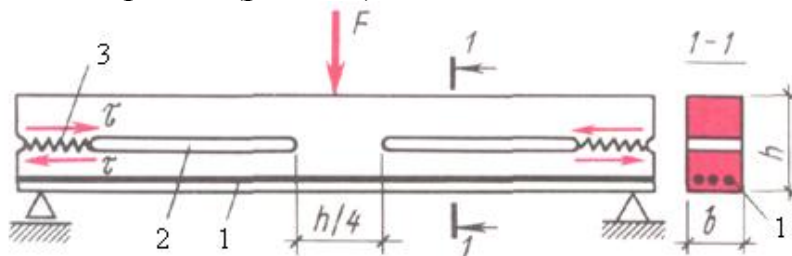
Схема випробування бетонного зразка на сколювання: 1 - робоча арматура; 2 - прорізи (щілини); 3 - ділянки, де відбувається сколювання бетону
